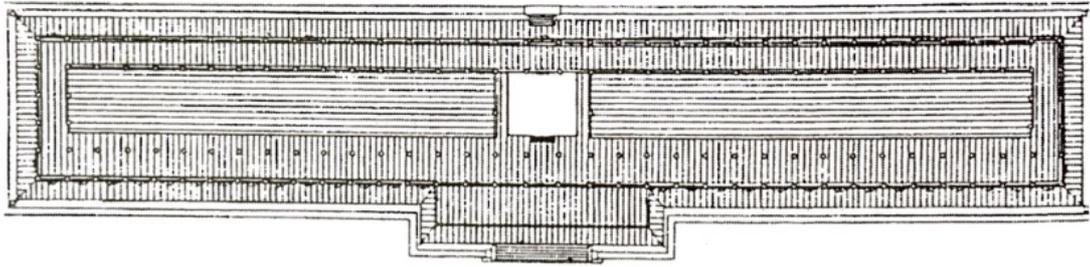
蓮華王院本堂(三十三間堂)の平面図⁸⁾
